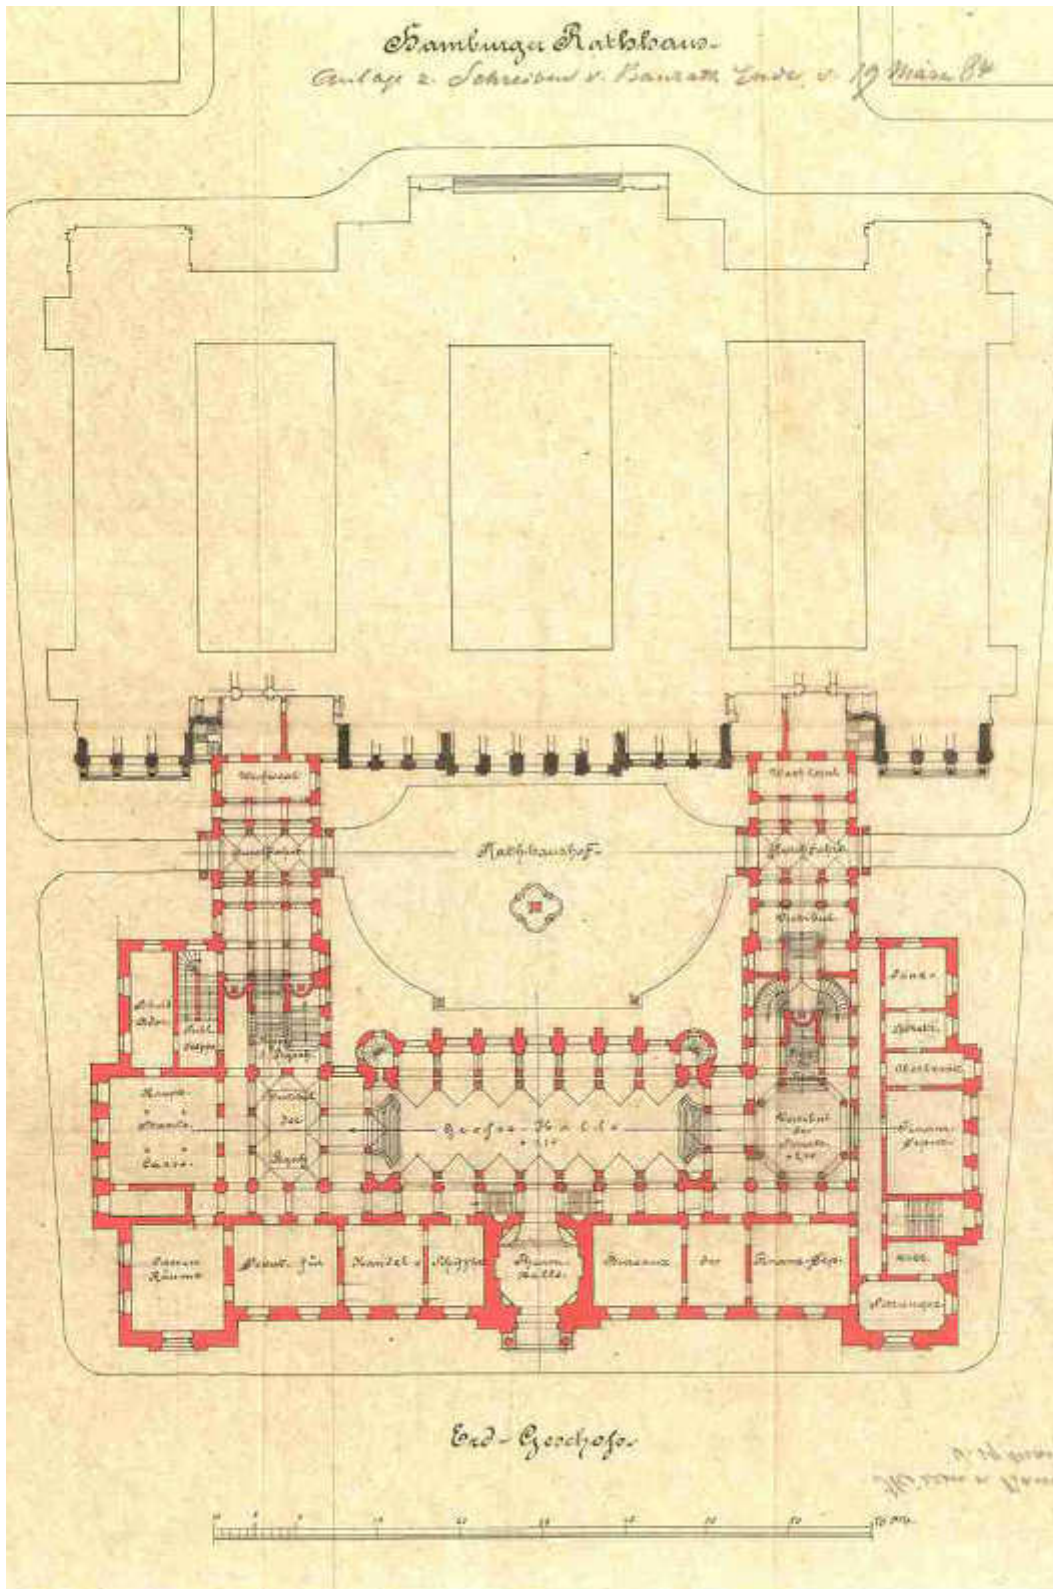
Grundriss Erdgeschoss, von Hermann Ende abgeändert am 19. März 1884.
